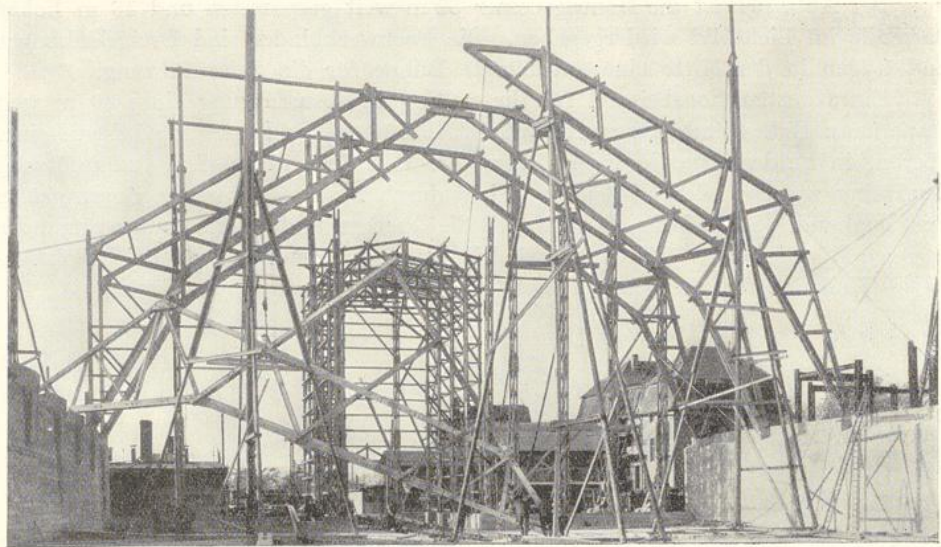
System „Deutsche Hallenbau A.-G.“ (Dehall). Zweischiffige Lagerhalle.
